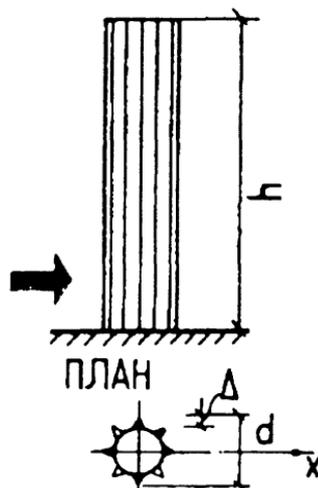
Расчетная схема ветровых нагрузок на колонны
